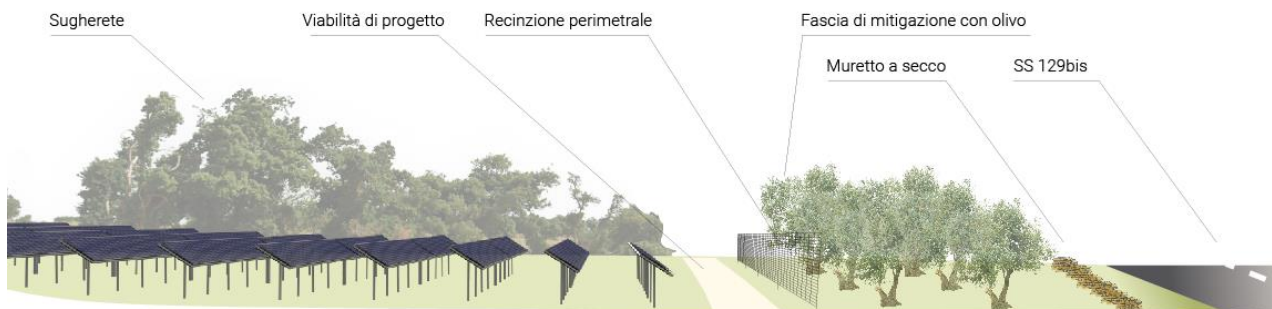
SEZIONE PAESAGGISTICA TIPOLOGICA DELL'IMPIANTO
